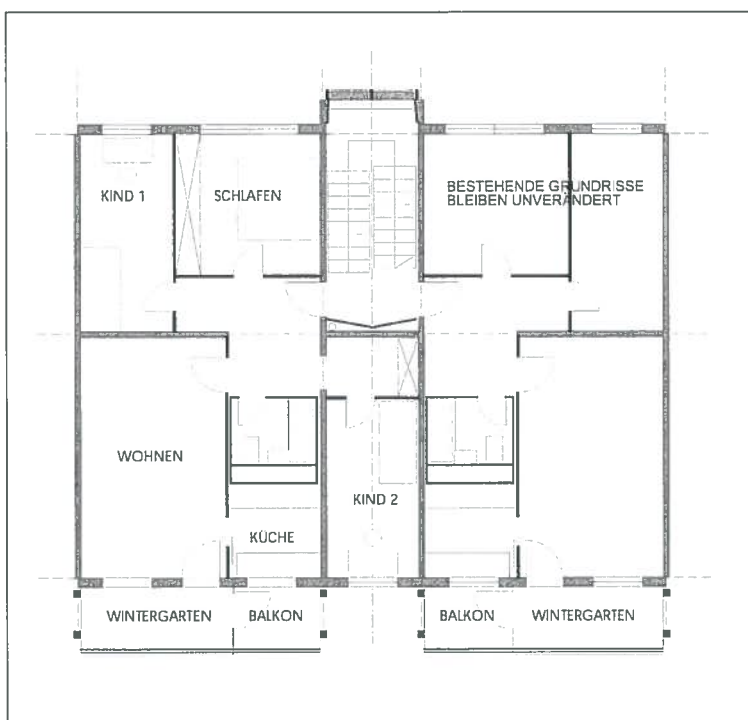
Pianta del piano tipo di una porzione tipo dell'edificio.
